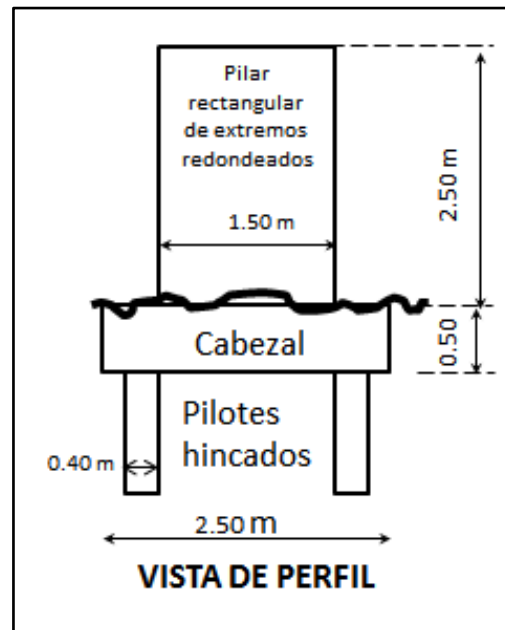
Vista de perfil sistema de pila de fundación puente Las Flores. Dibujo sin escala.
